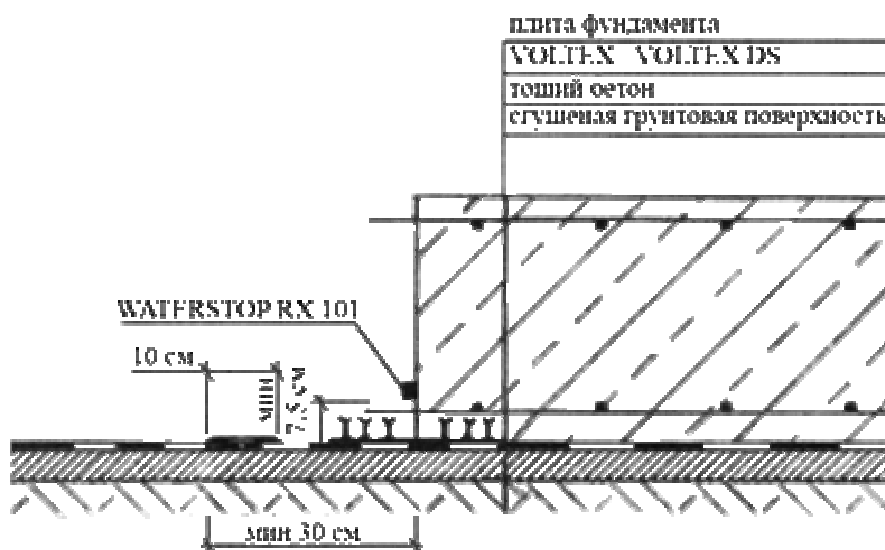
Укладка гидроизолирующих матов при наличии технологического перерыва в бетонировании плиты фундамента
